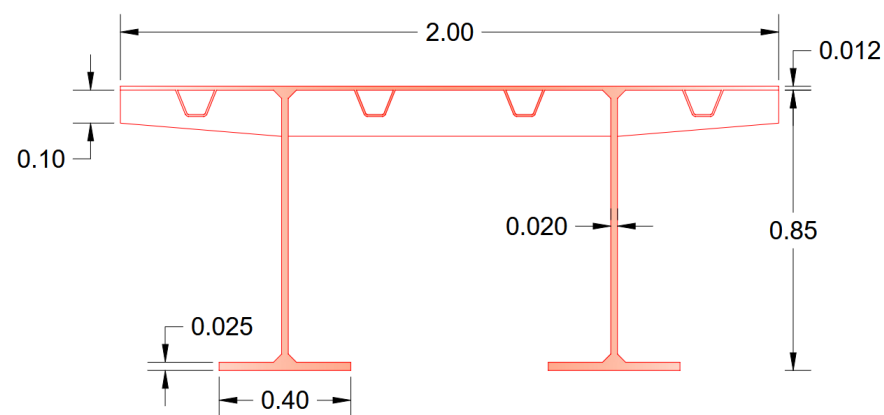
Sección de acero estructural. Fuente: Elaboración propia.
